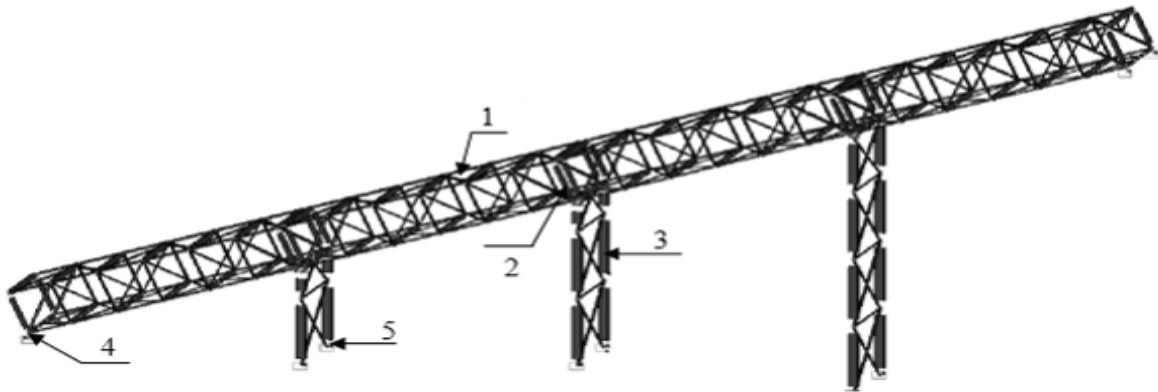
Основные конструктивные части решётчатой конвейерной галереи: 1 — пролётное строение, 2 — ветровая рама, 3 — плоская (шарнирная) опора, 4 — неподвижная (анкерная) опора, 5 — опорное закрепление.
